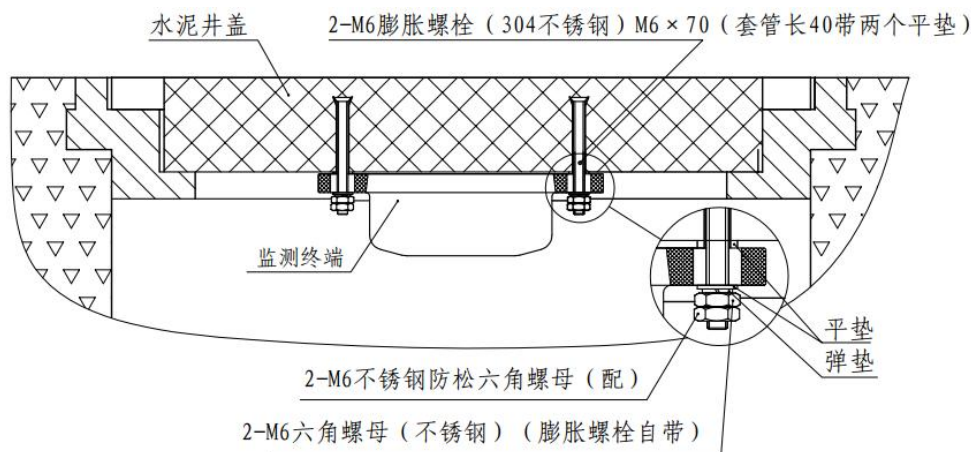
钢筋混凝土井盖安装示意图（安装附件 CS-iTWM-08-A04）
